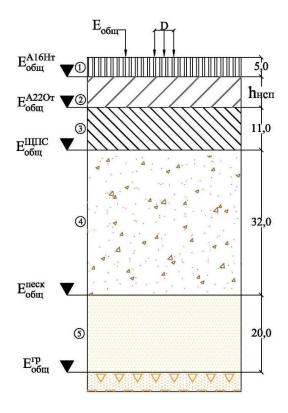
Расчётная схема конструкции дорожных одежд, устроенных раздельной укладкой нижнего слоя покрытия и верхнего слоя основания:
